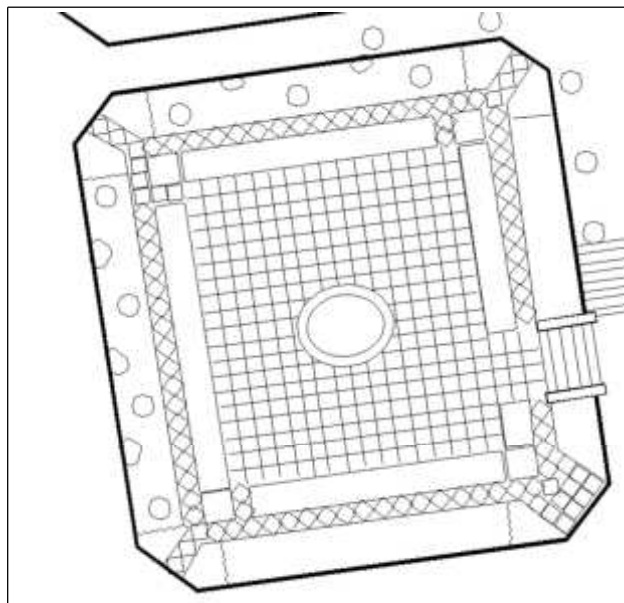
Specialplan Migge 1913, Ausschnitt Brunnenhof (Nachzeichnung)
